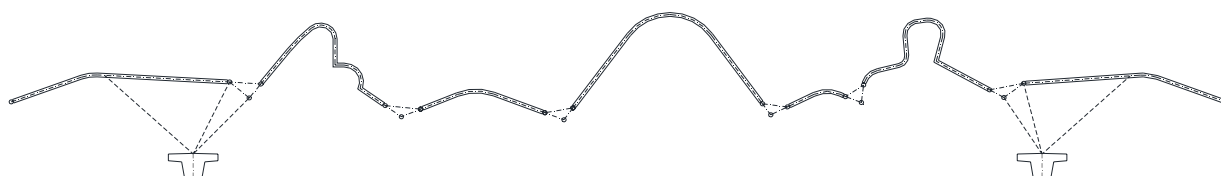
Sección de la cubierta por los lucernarios de Santa Caterina y Sant Domenech
